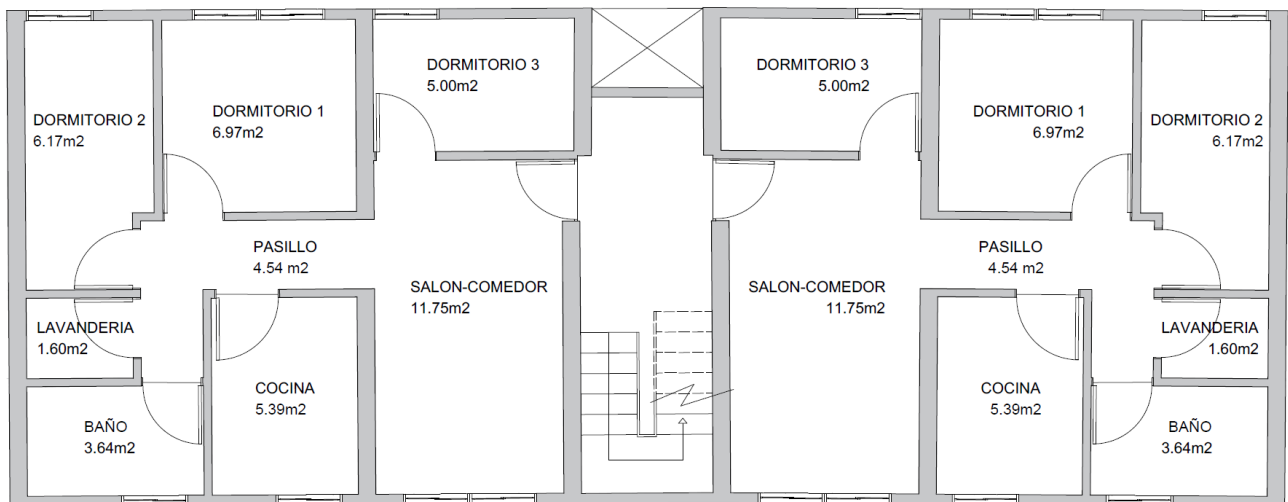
Plano Distribución P1-P4 Sin Pavimento.
